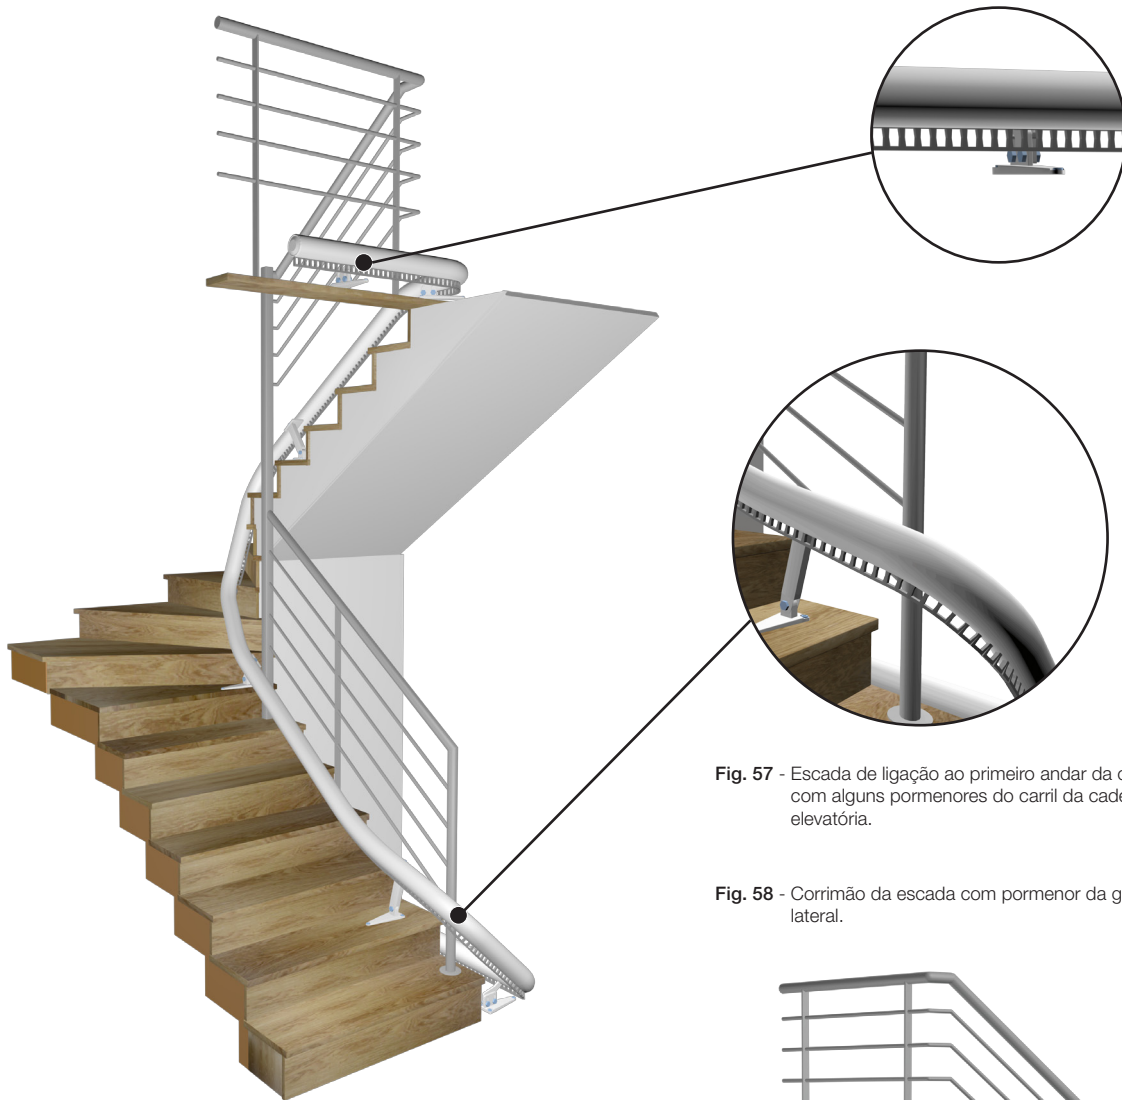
Escada de ligação ao primeiro andar da casa com alguns pormenores do carril da cadeira elevatória.
